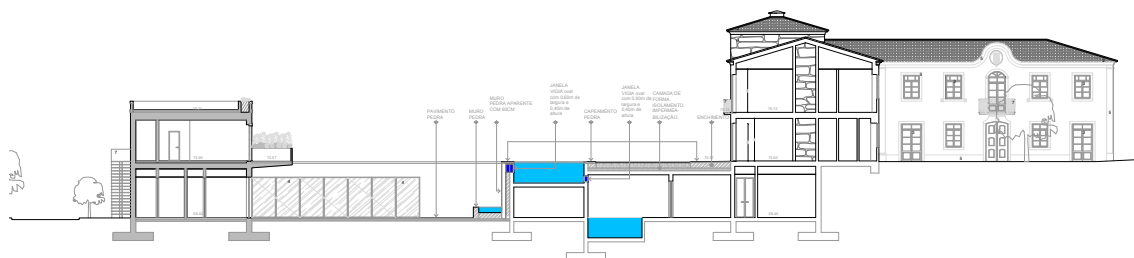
Corte longitudinal (2022). Fuente: Queiras & Xedas Construções.
